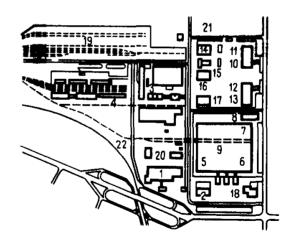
Формирование схем генеральных планов промышленно-коммунальных зон (продолжение)
